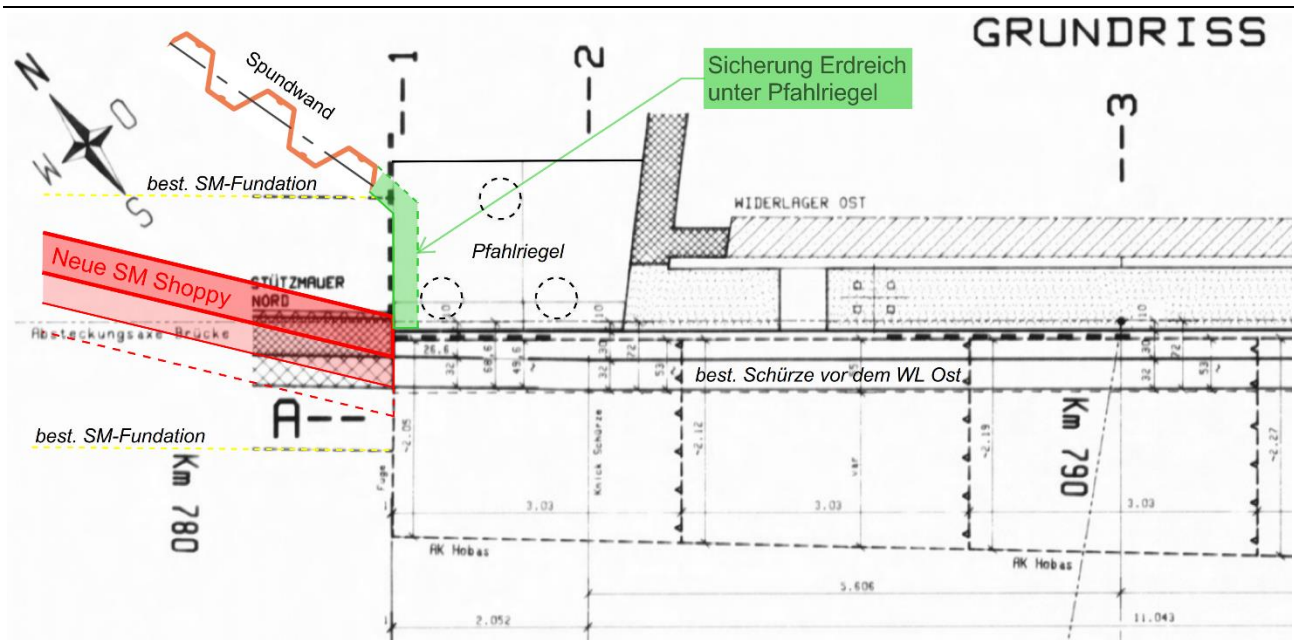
Grundriss Anschluss neue SM Shoppy an UEF SBB im Sand
